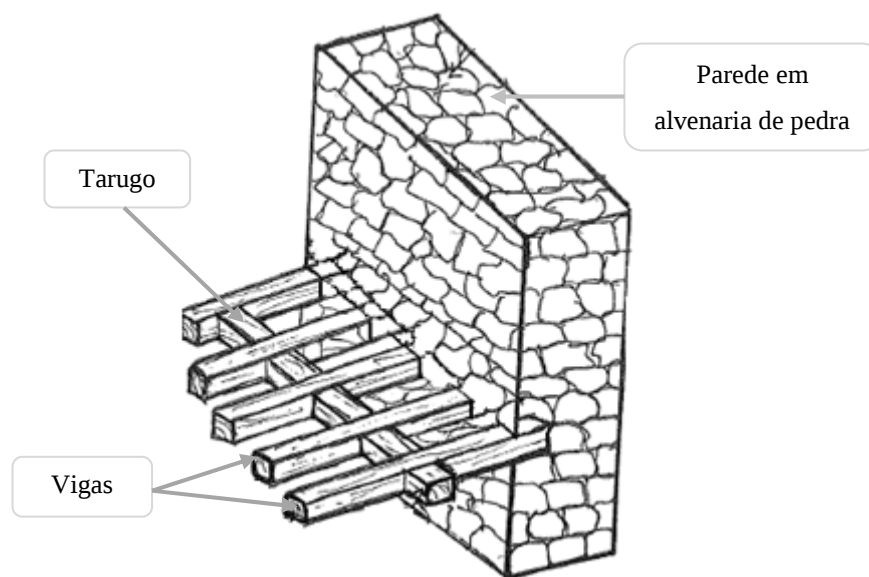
Pormenor construtivo da ligação do vigamento a parede de alvenaria de pedra.
